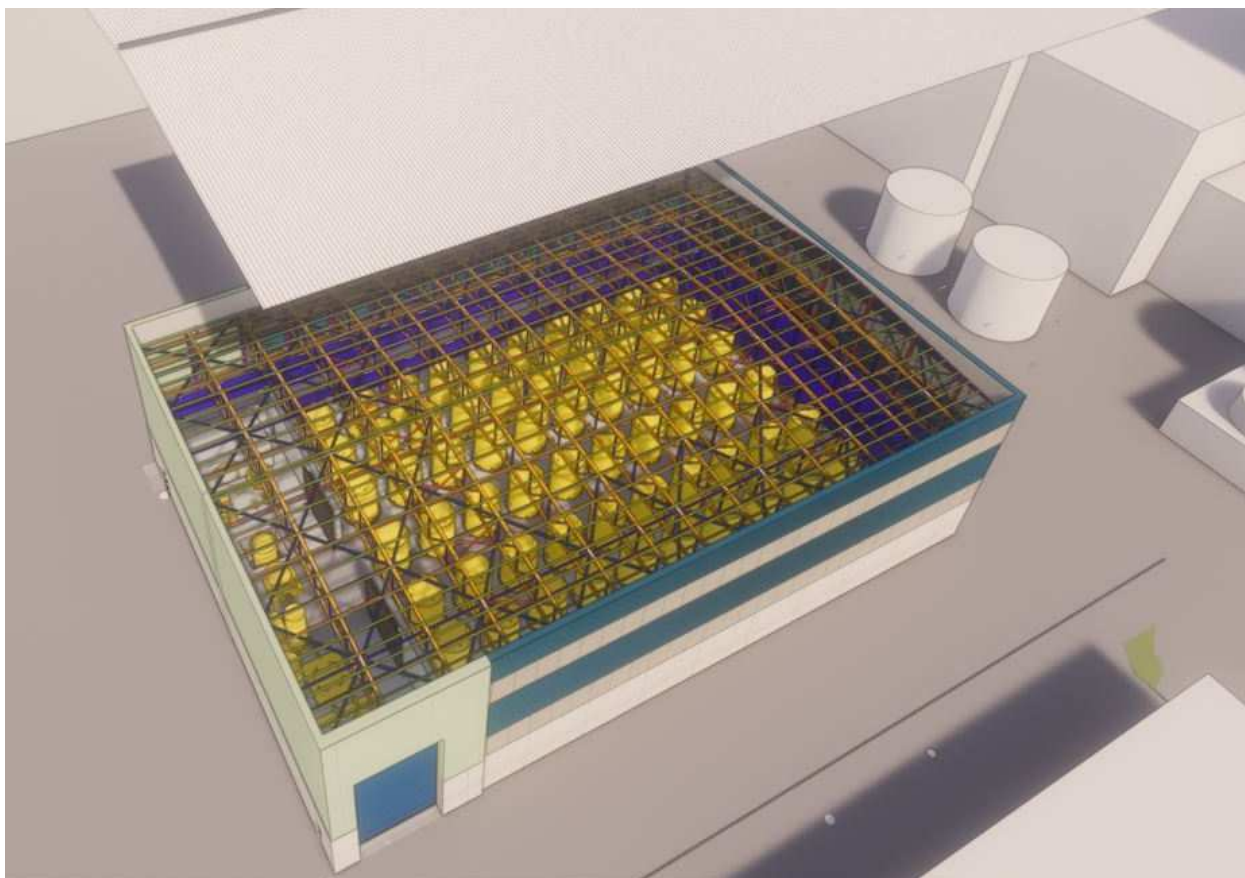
3D-Darstellung des Trockenlagergebäudes – Tragkonstruktion und Fassaden
